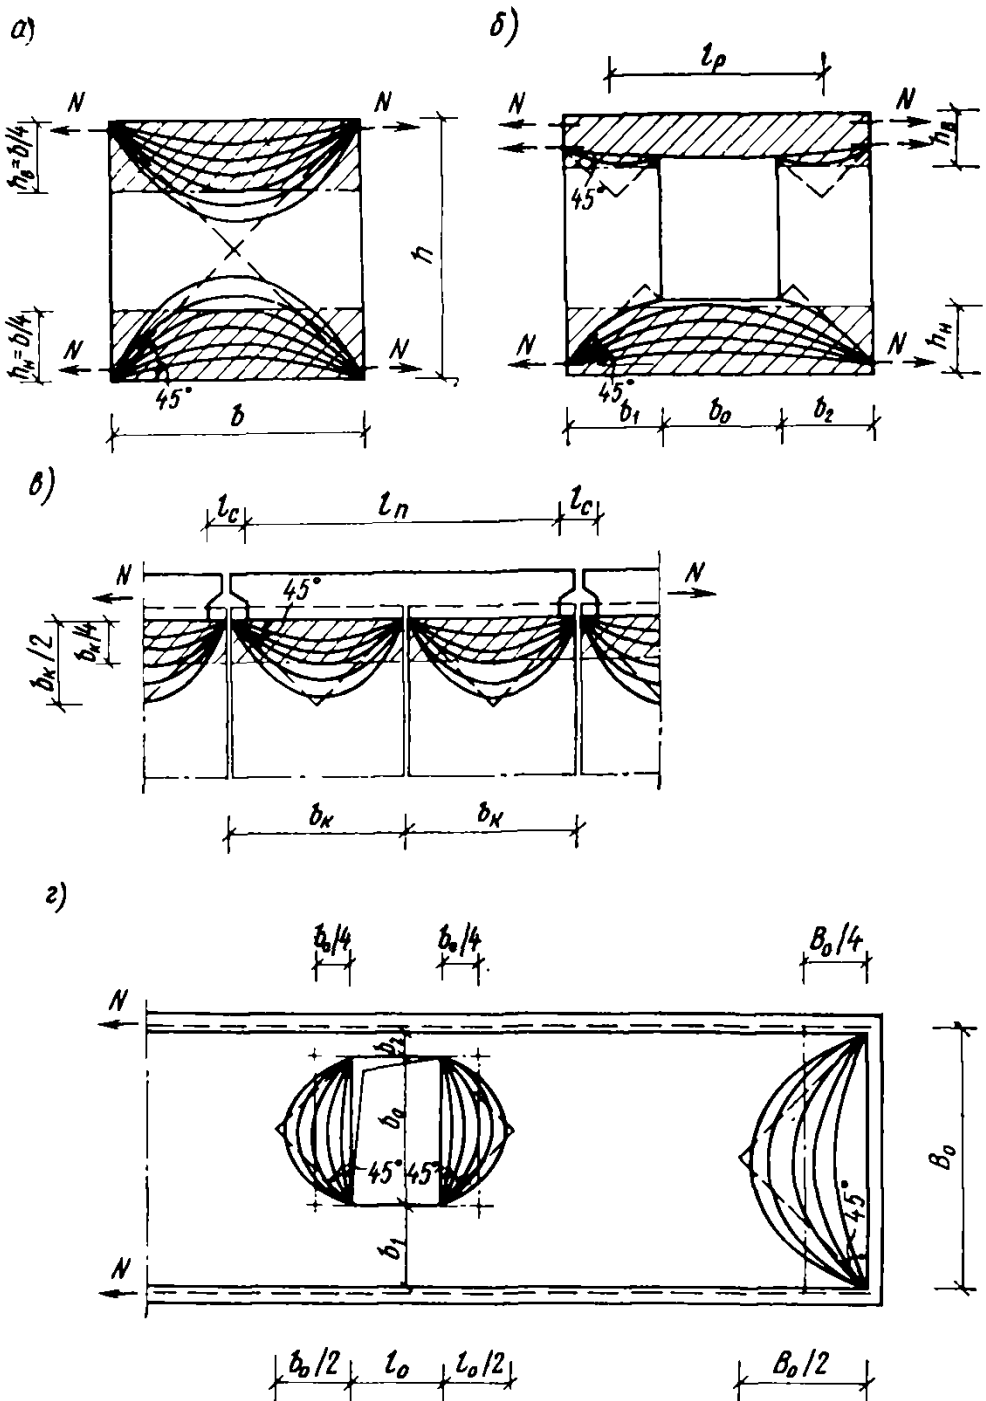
Зоны влияния связей и проемов на распределение продольных усилий и напряжений в стеновых панелях и плитах перекрытий
